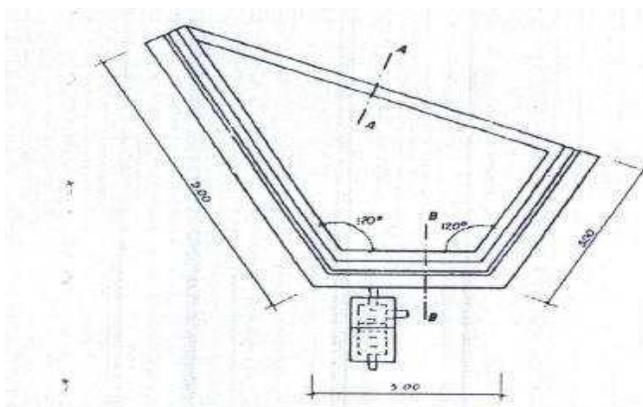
vista en planta de la planta y la cámara de rebose. (Aquaupia, 2019)
